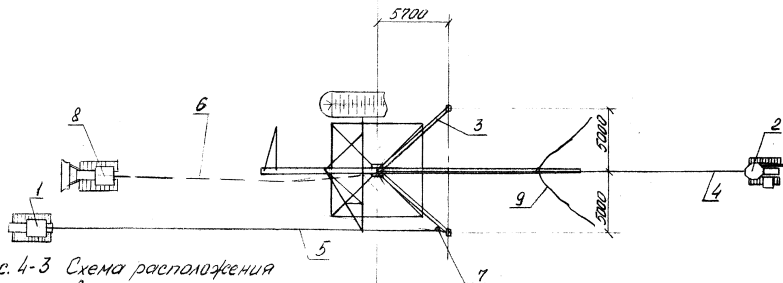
Схема расположения механизмов и такелаж при установке опоры (вид сверху).
